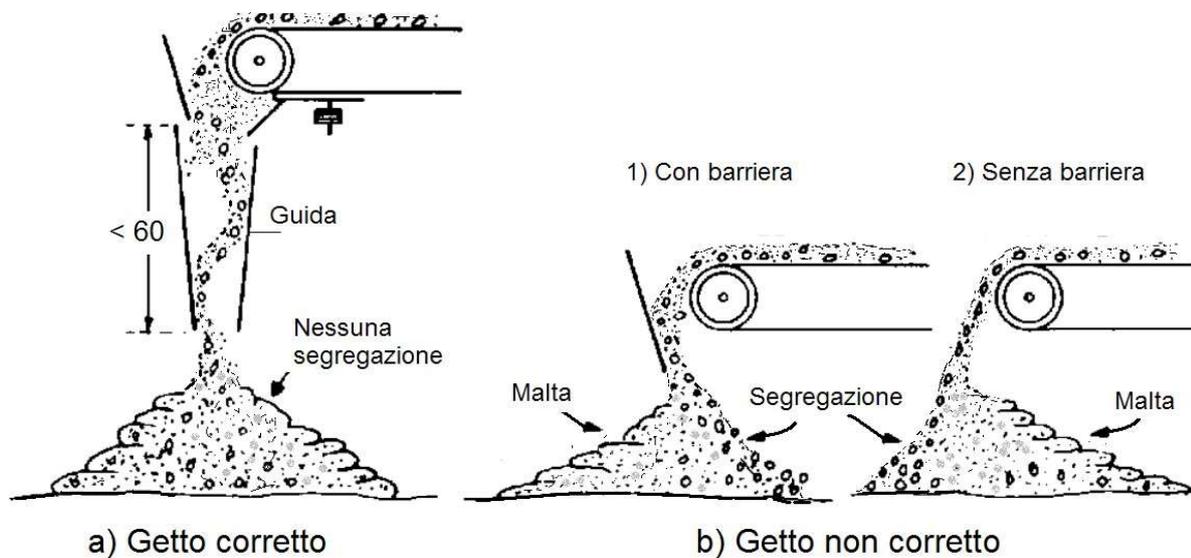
Esempi di getto di calcestruzzo con nastro trasportatore: a) getto corretto e b) getto non corretto. Nel caso b) si ha la separazione degli aggregati dalla malta cementizia. La barriera comporta soltanto il cambiamento di direzione della segregazione.
